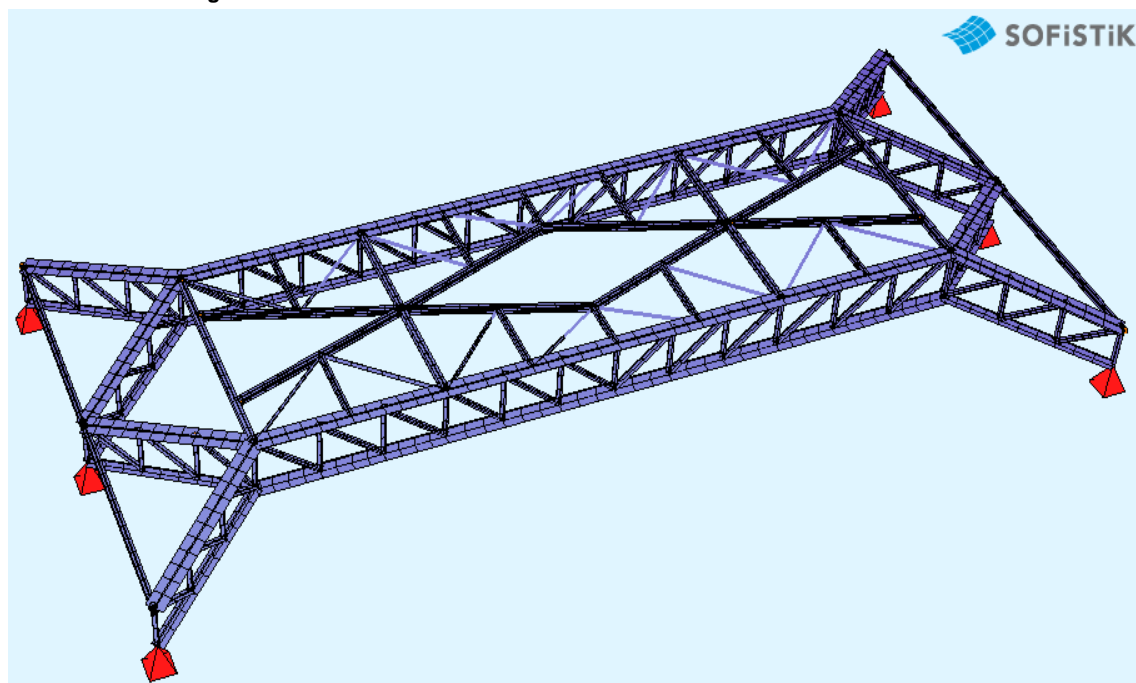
Modello di calcolo – Vista estrusa del modello trave reticolare
